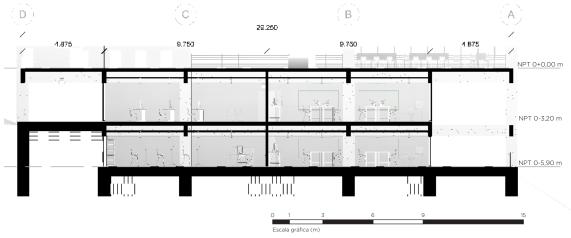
Corte transversal de los talleres y laboratorios E-E'
